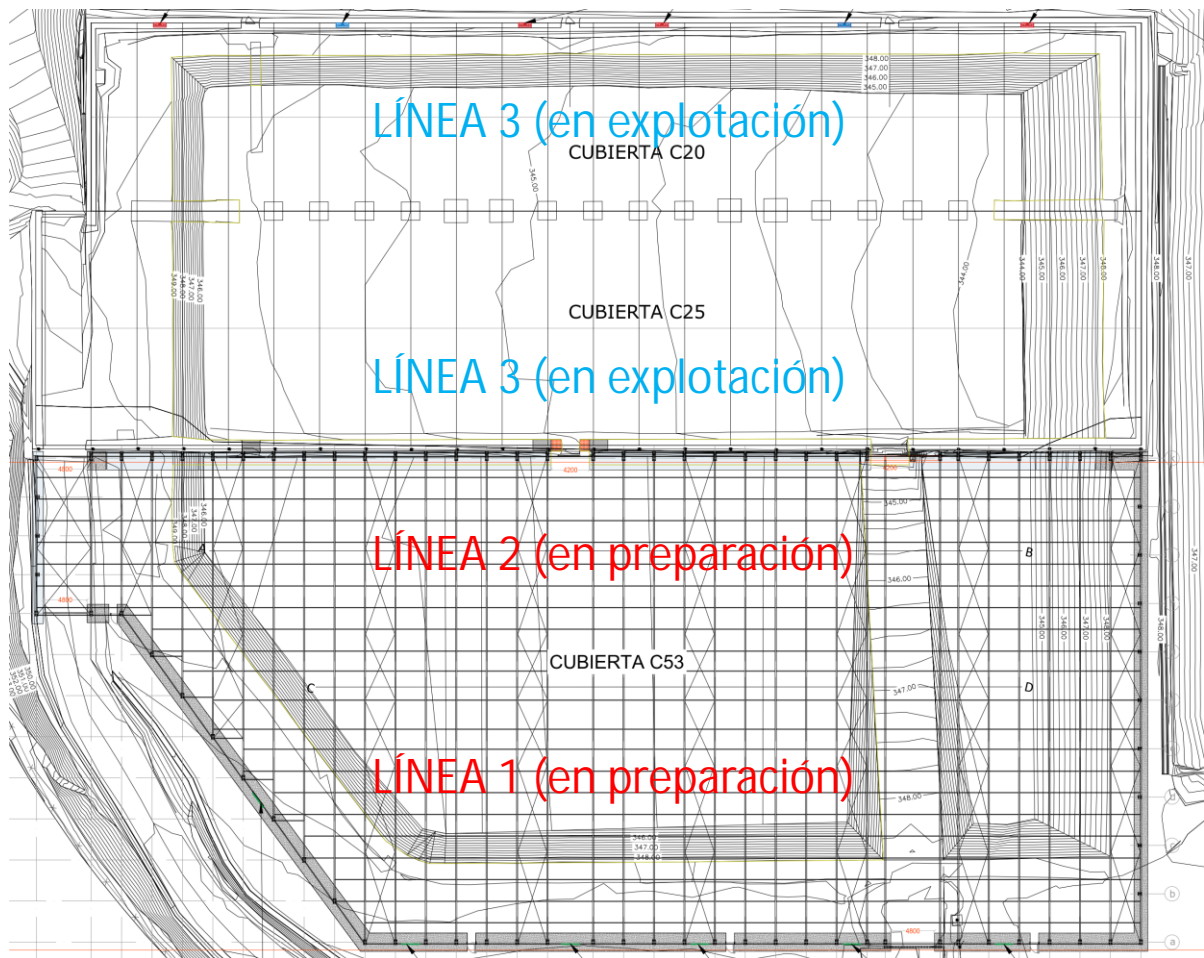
Plano de planta de las tres cubiertas de la sección II de la celda 29
